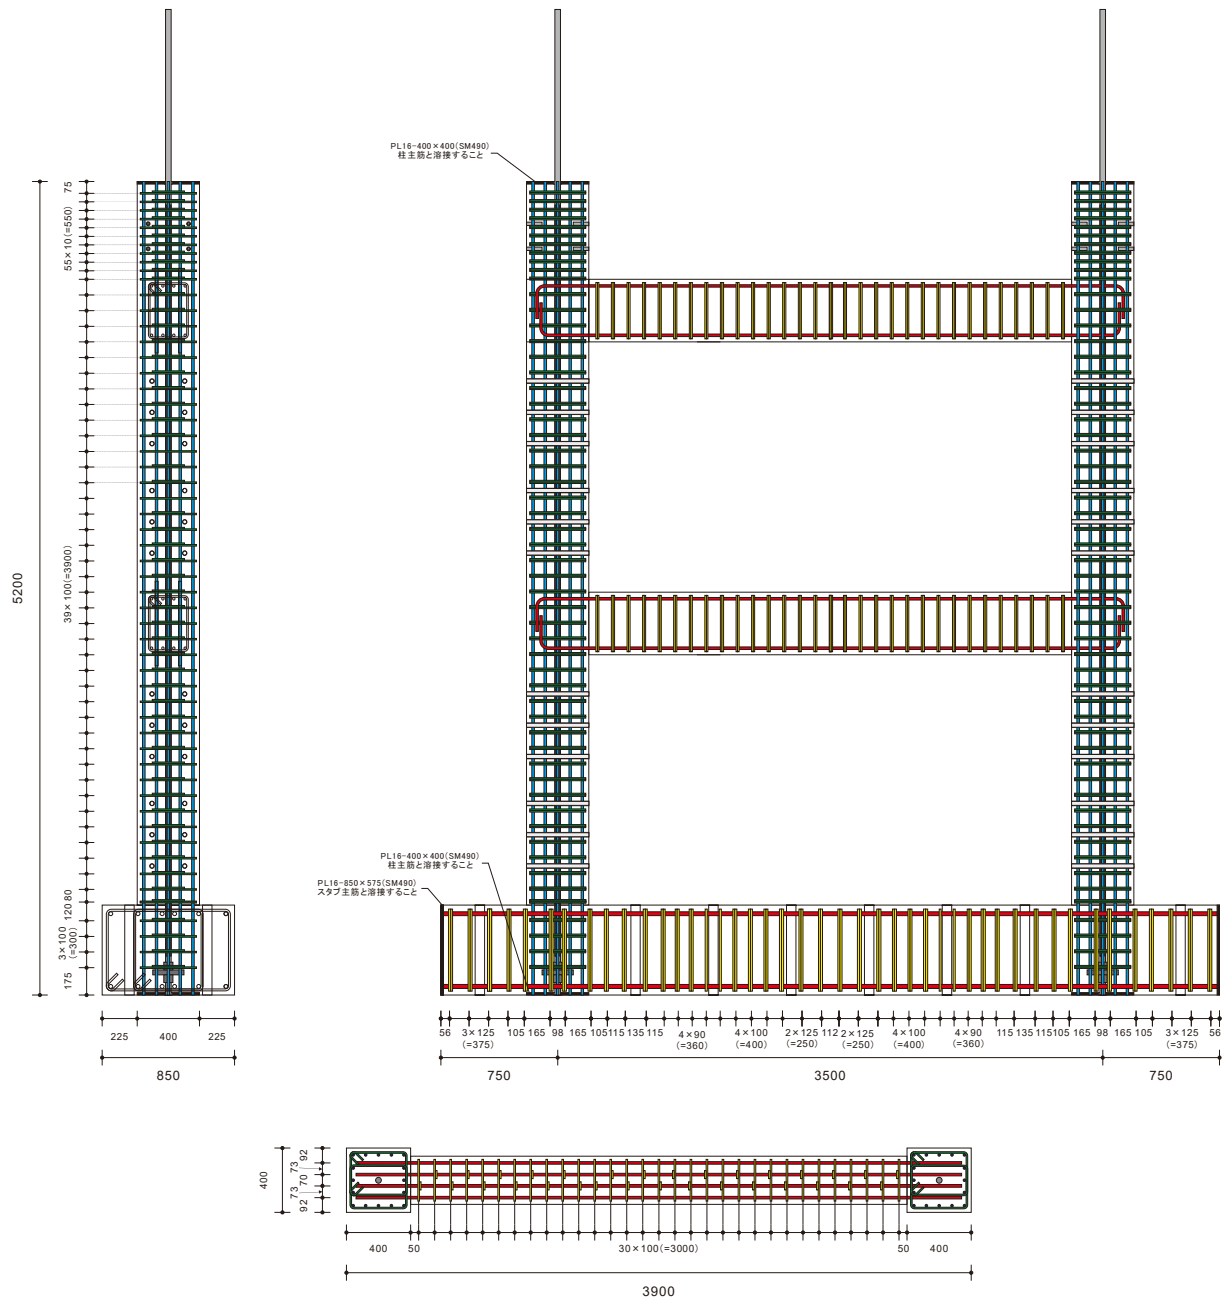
試験体 WB の RC 部分の配筋図 (単位:mm)
